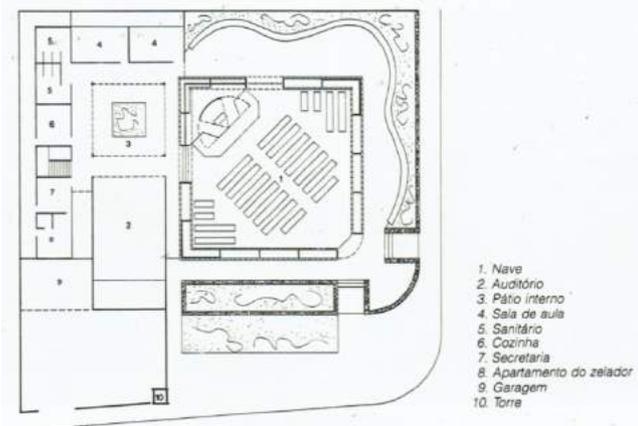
Planta Baixa Igreja do Bom Samaritano. Fonte: Revista Projeto, nº137, 1992.
